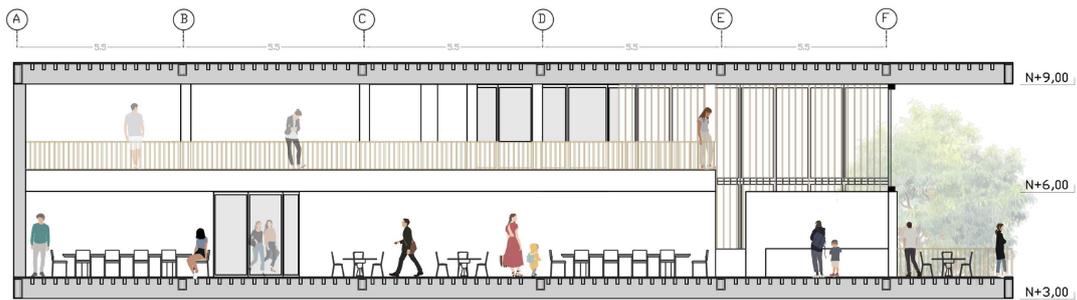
Alzado interior 2 pizzería. Elaboración propia
